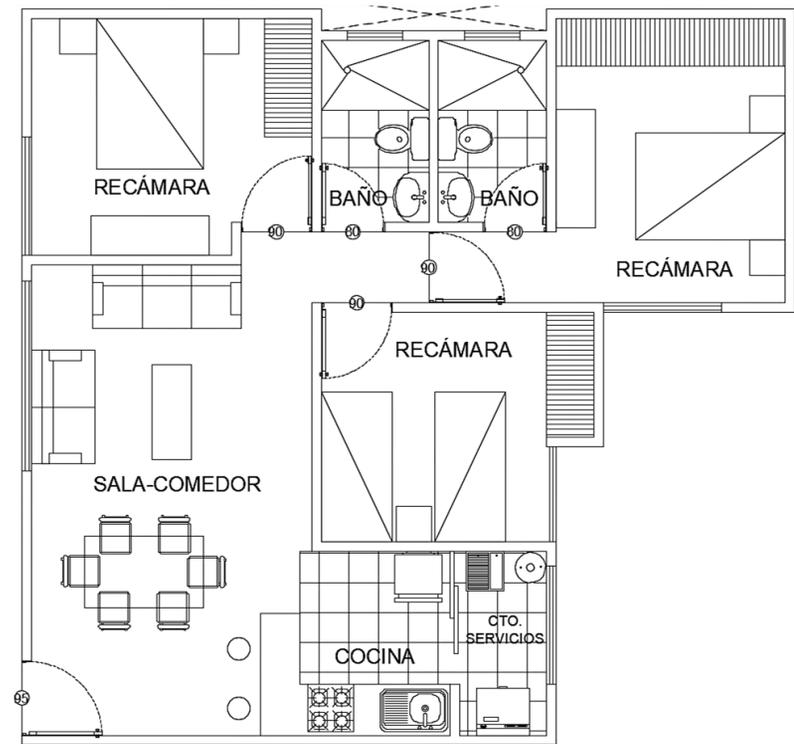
Pantitlán Planta tipo. 73.78 m²
